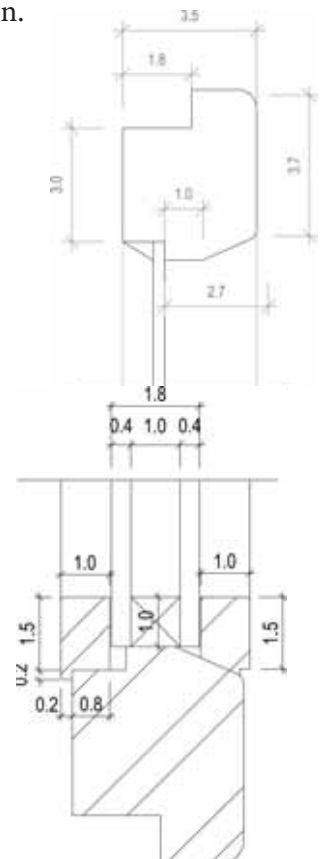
Detailplan Fenster ca. 1950 (oben mit Originalverglasung, unten mit Wärmeschutzglas)
